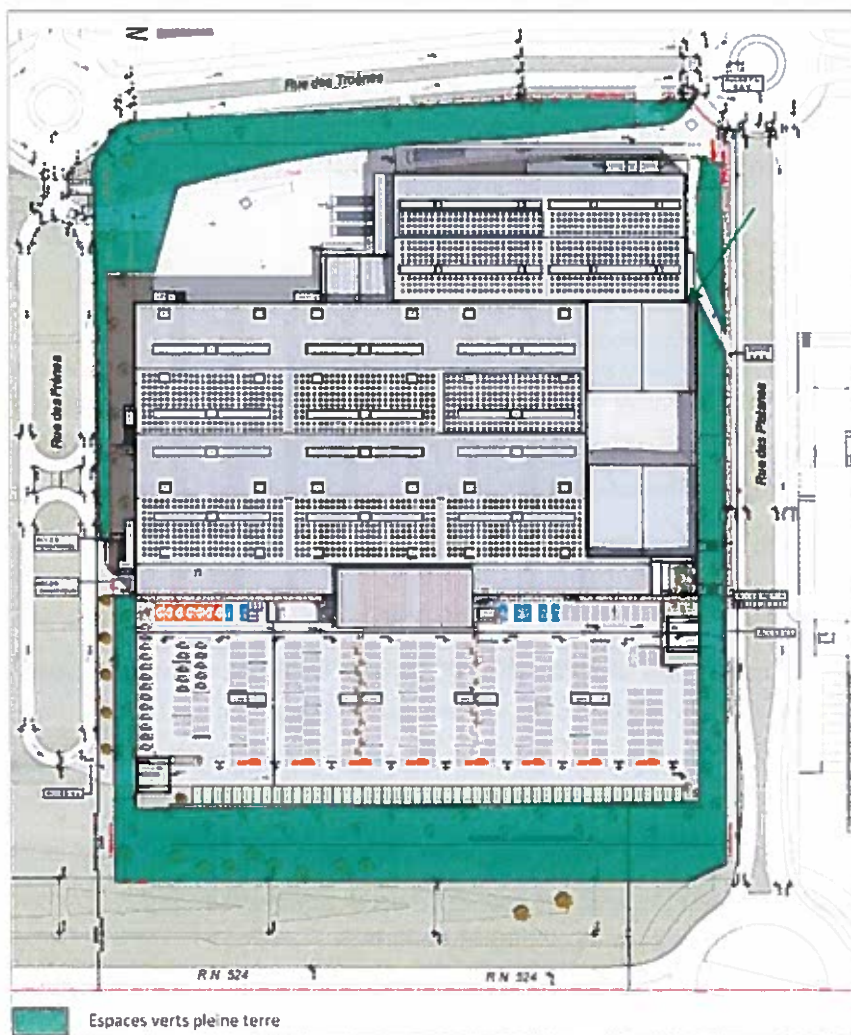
Plan de masse (URB1N-Agence d'architectes-Décembre 2017 ; CERAG)
